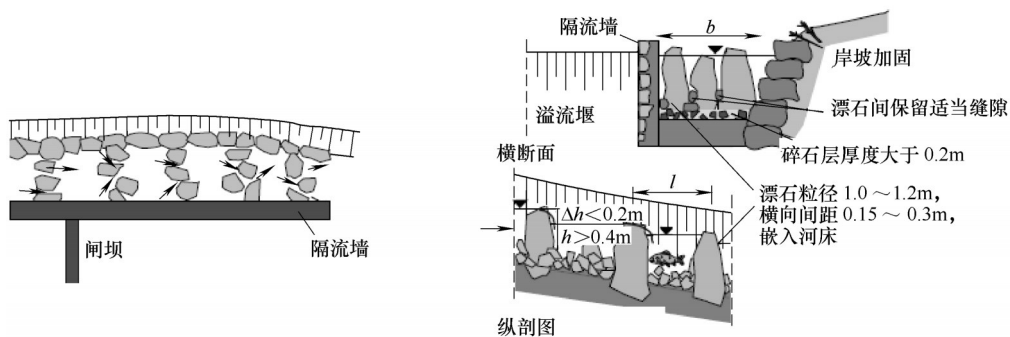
过鱼副坝的典型布置(左侧为平面布置图，右侧为纵剖图与横断面图)
